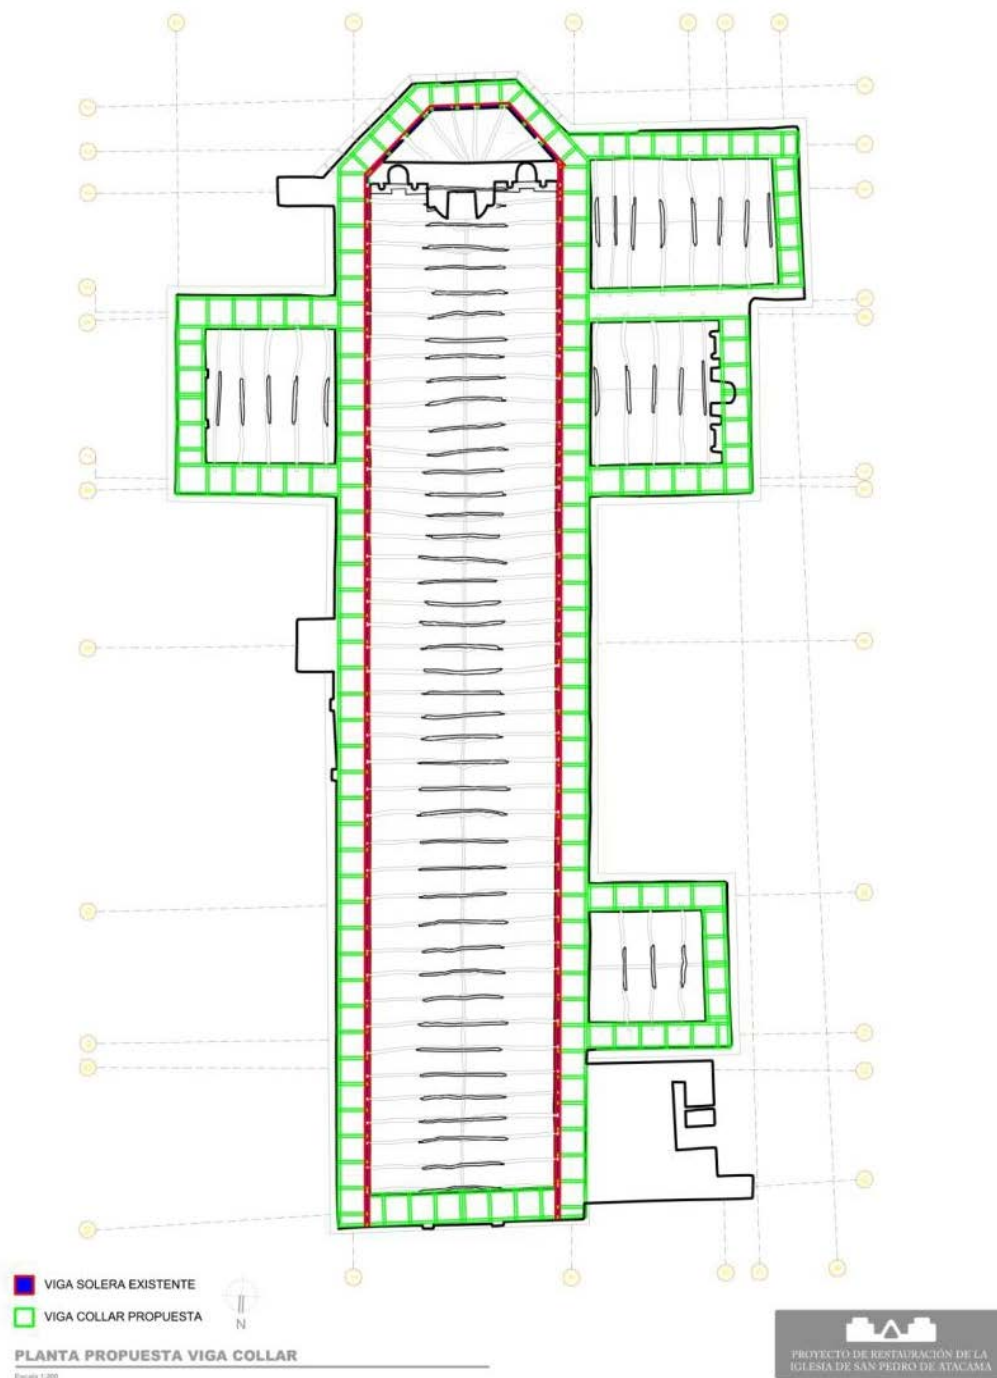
Planta de viga solera existente y viga collar propuesta como reforzamiento
